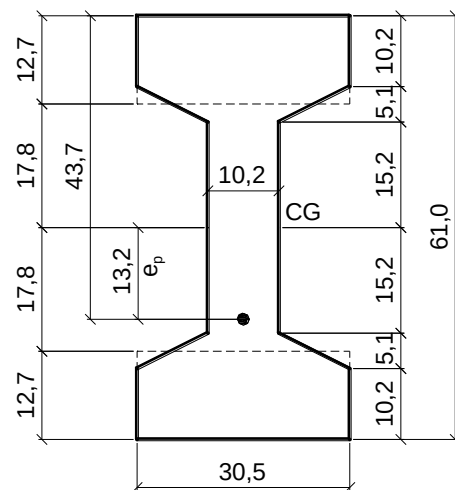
Dimensões (cm) da seção transversal da viga.
